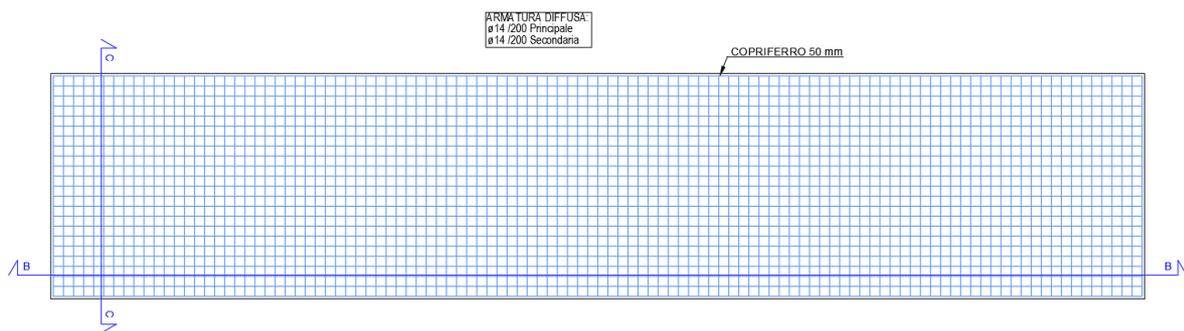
Prospetto frontale con platea di Fondazione della Cabina di Centrale
